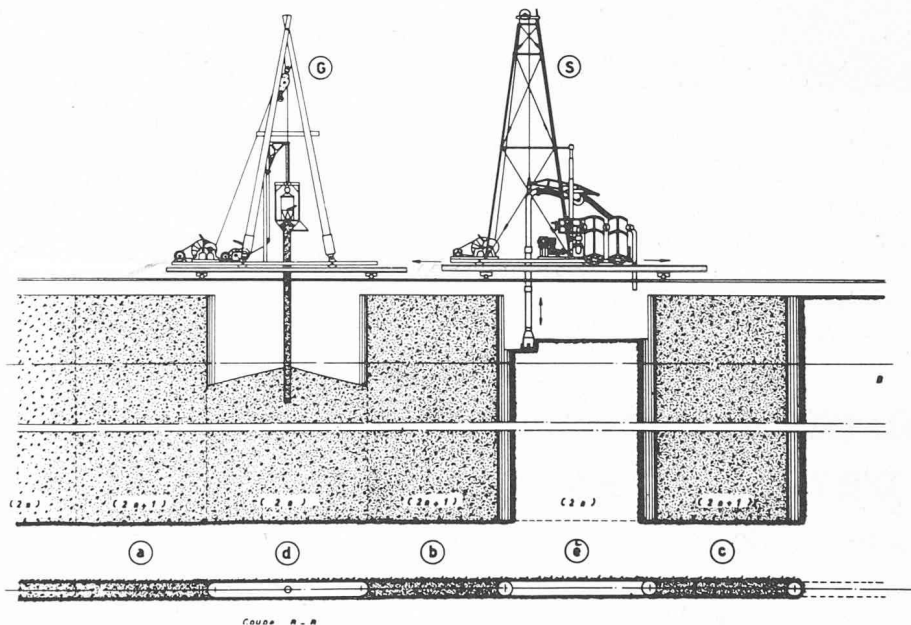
b. — Excavation et bétonnage des tranchées série paire.
